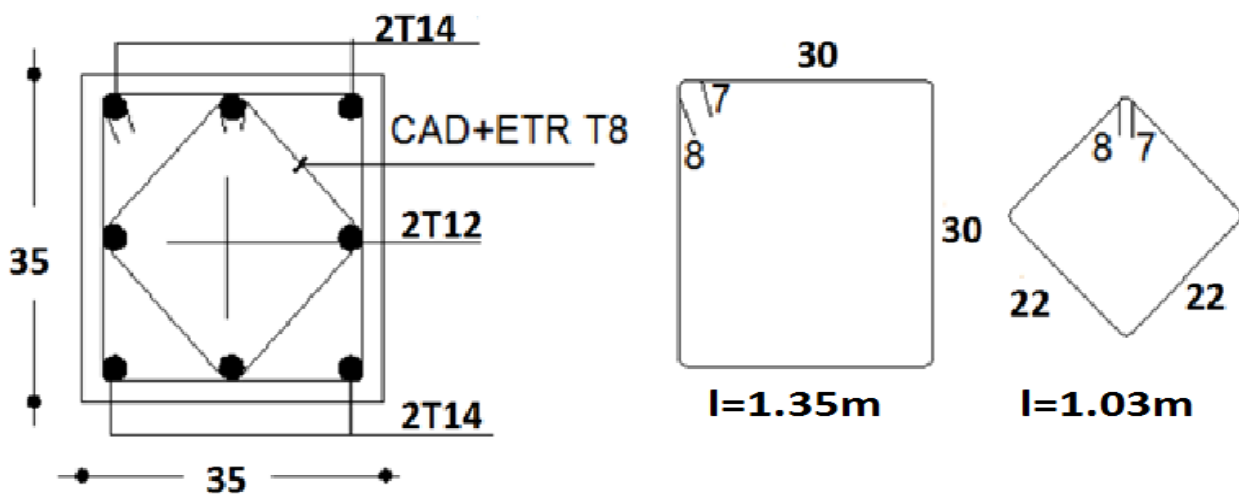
Coupe du ferrailage des poteaux 35x35
